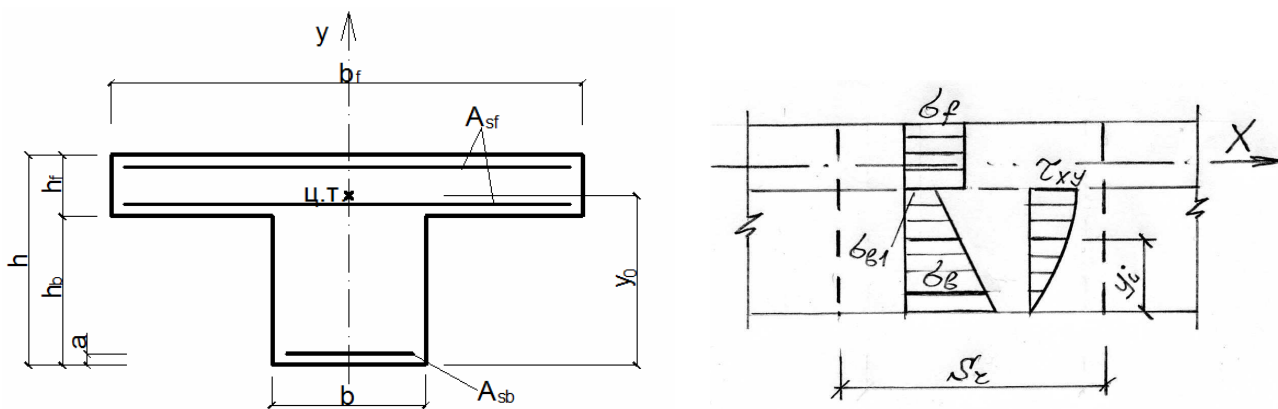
Схема к определению в железобетонном элементе таврового сечения усадочных напряжений
